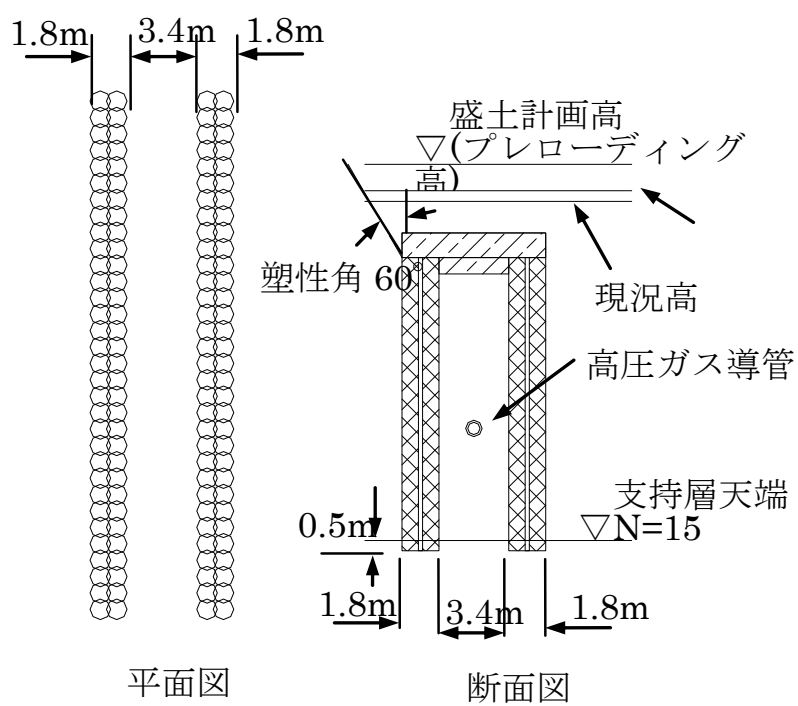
TYPE-4 の改良杭配置(左：平面図，右：断面図)
